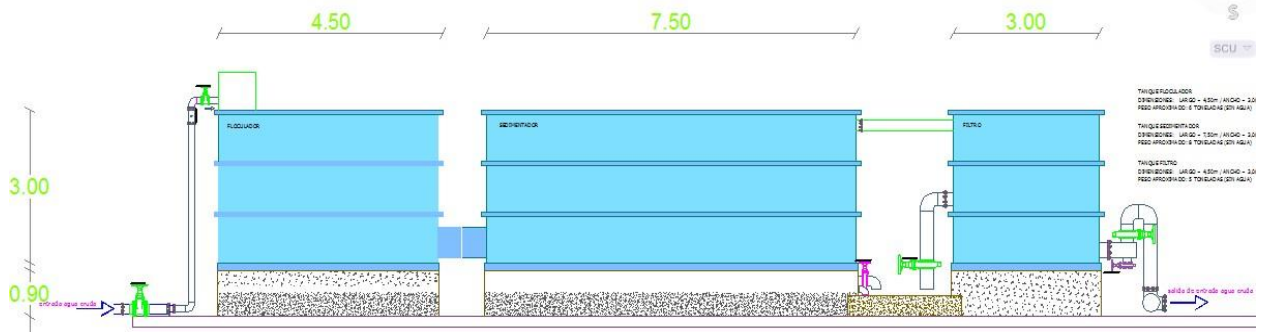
Vista en corte, planta de tratamiento modular 2D
